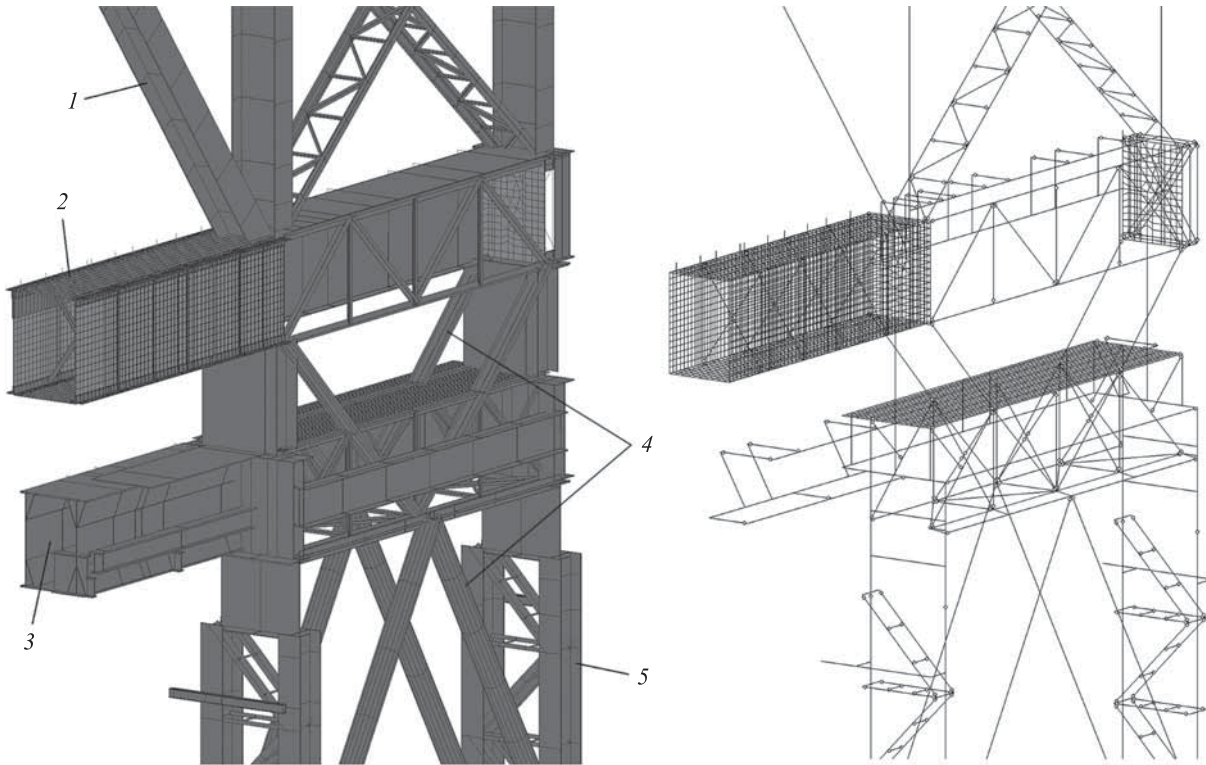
Фрагмент расчетной модели в зоне опирания подкраново-подстропильных ферм на колонны каркаса: 1 — опорный раскос ППФ; 2 — нижний пояс ППФ; 3 — подкрановая балка завалочного крана; 4 — вертикальные связи; 5 — двухветвевая колонна каркаса
